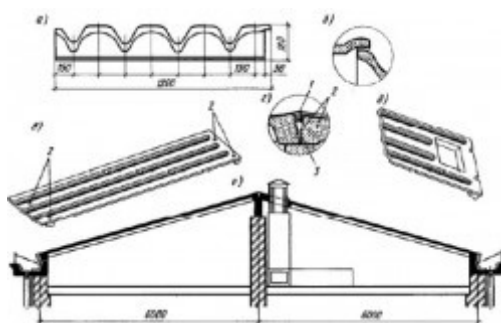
Сборная железобетонная скатная крыша из волнистых панелей:
